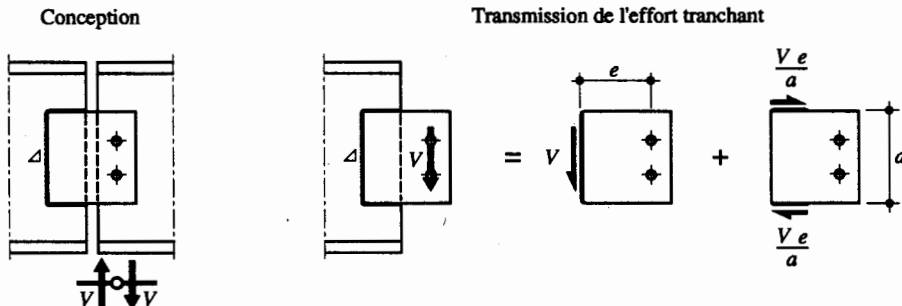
Joint de poutre par couvre-joint d'âme boulonné et soudé.
